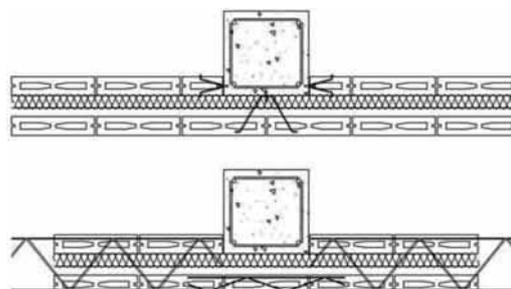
Plantas de encuentros de muro de cerramiento de 2 hojas (DCW), con cámara de aire y aislamiento, con pilares en el paño: hiladas pares, hiladas impares.
